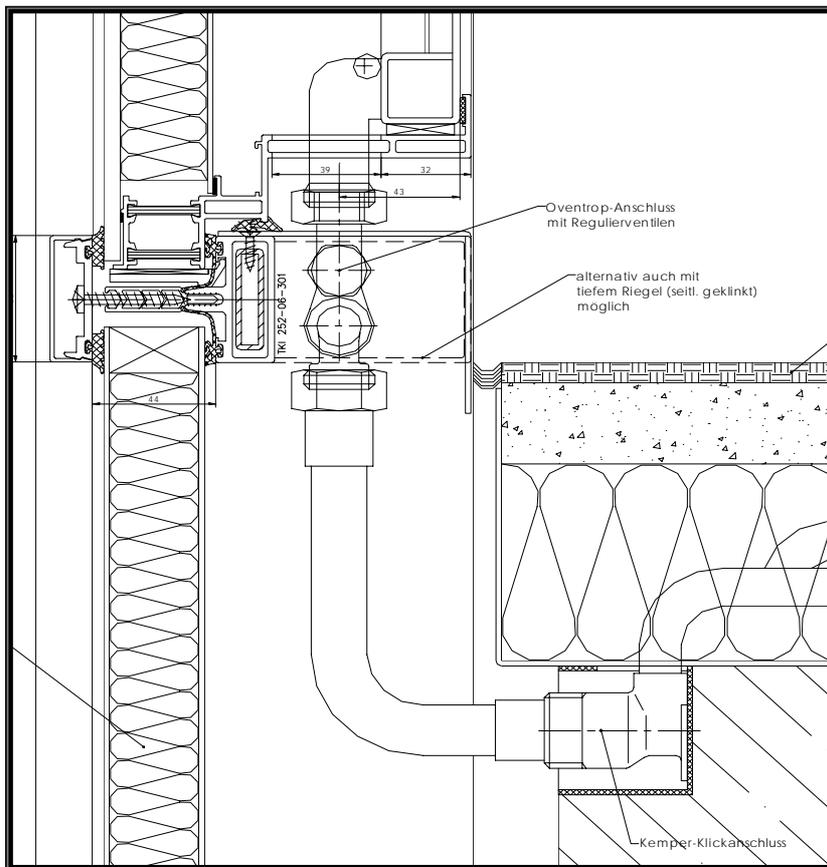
Detail aus Vertikalschnitt mit schwenkbaren Anschluss
